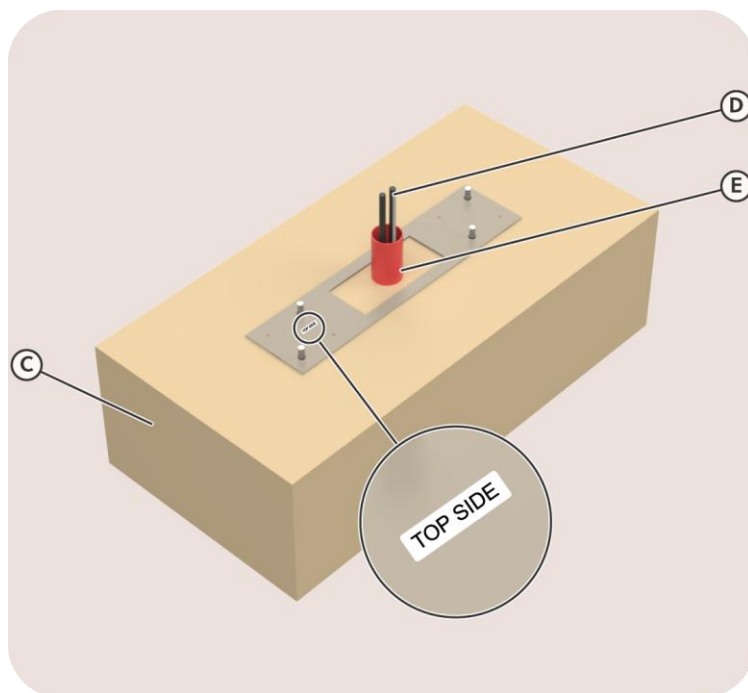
Exemple d'une fondation solide (C), avec des câbles (D) dans un système de conduits flexibles (E)
